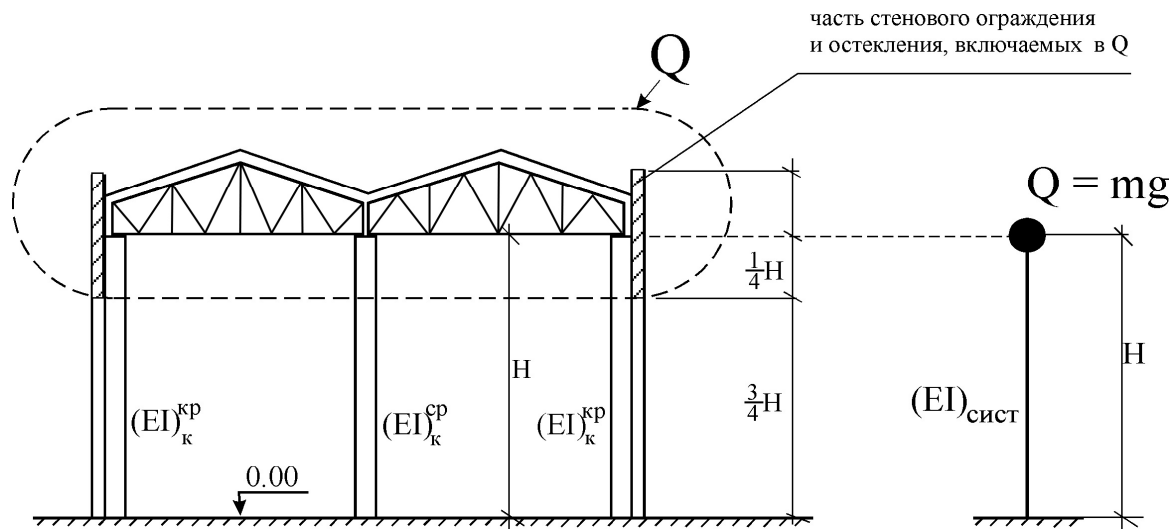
Формирование динамической расчетной схемы при шарнирном сопряжении стропильной конструкции с колоннами.
